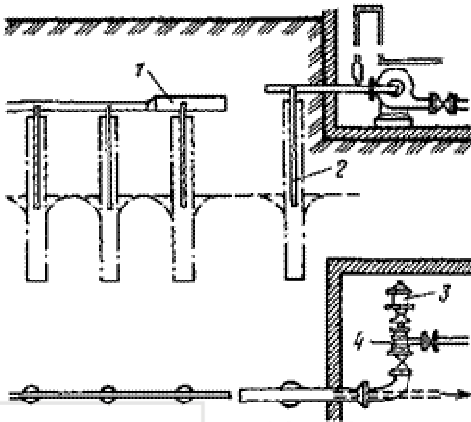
Схема влаштування вертикального дренажу із всмоктуючим трубопроводом:
